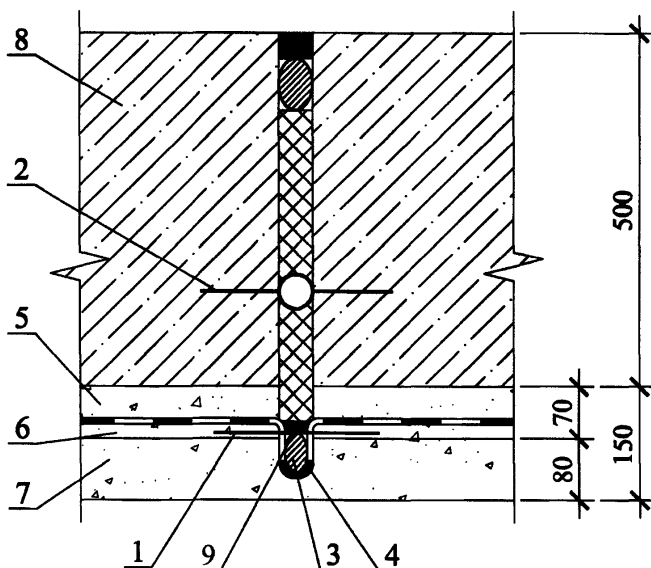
Герметизация усадочного шва в фундаментной плите при строительстве заглубленных и подземных сооружений
